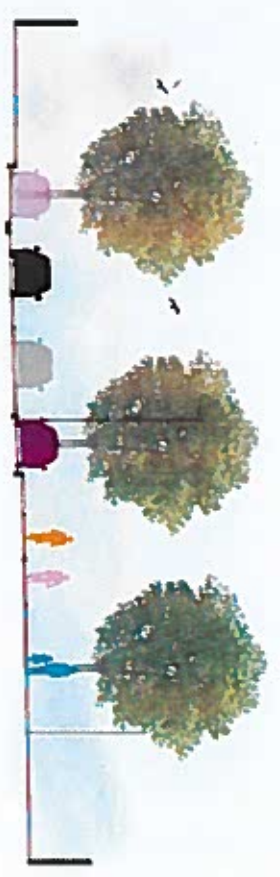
profil du boulevard Pont de Vivaux requalifié
